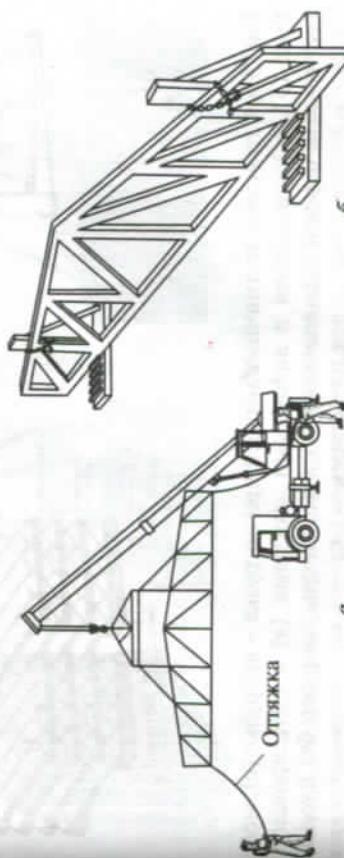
Строповка (а) и складирование ферм на металлических опорах (б)
